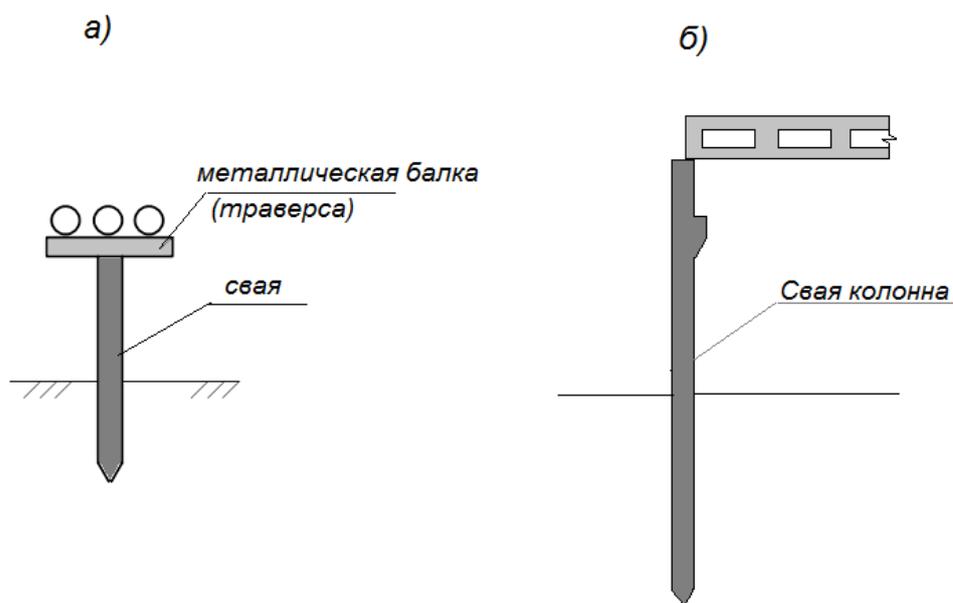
Примеры безростверковых фундаментов: а) – при прокладке надземных коммуникаций; б) - при устройстве свай-колонн
